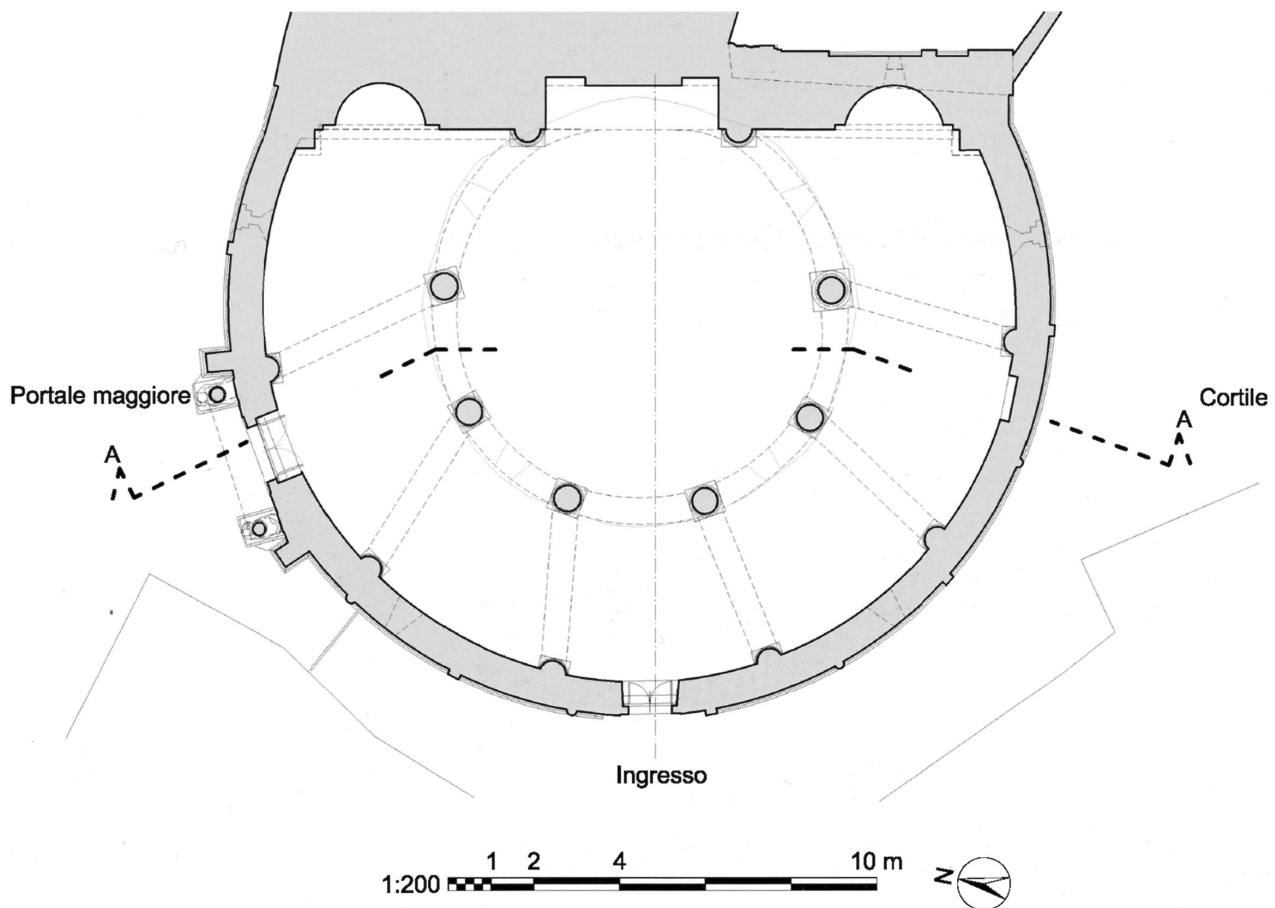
Brindisi, San Giovanni al Sepolcro, Grundriss
